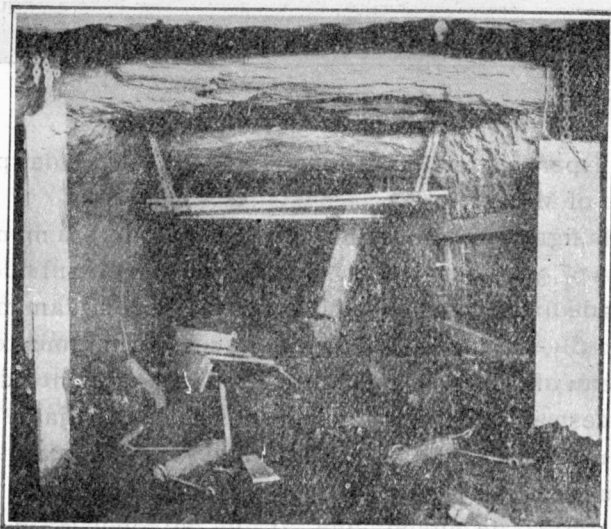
Efecto de una explosión fuerte sobre el tipo B.
